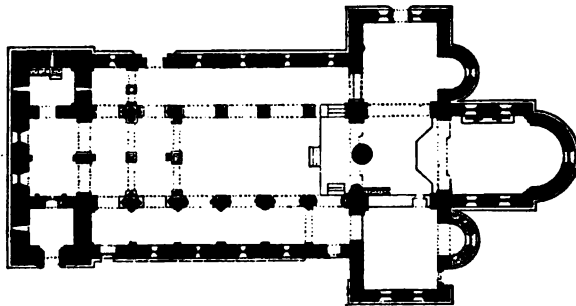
Grundriss einer romanischen Basilika
